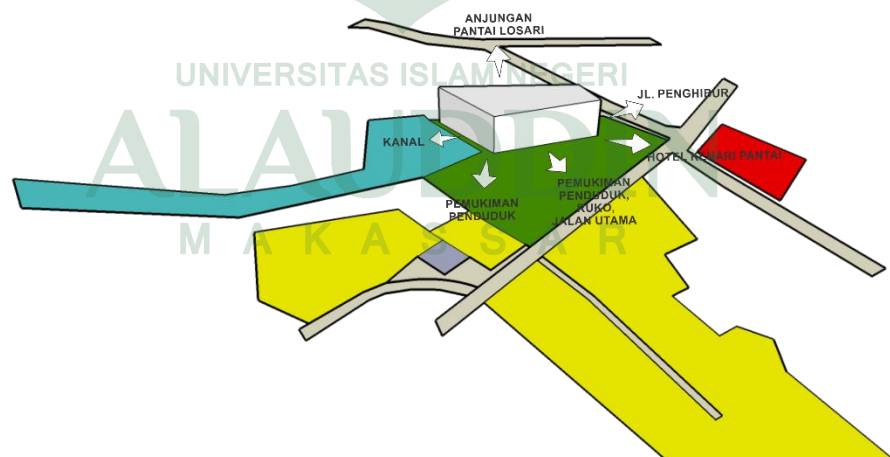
Bangunan Eksisting di Lokasi Tapak
